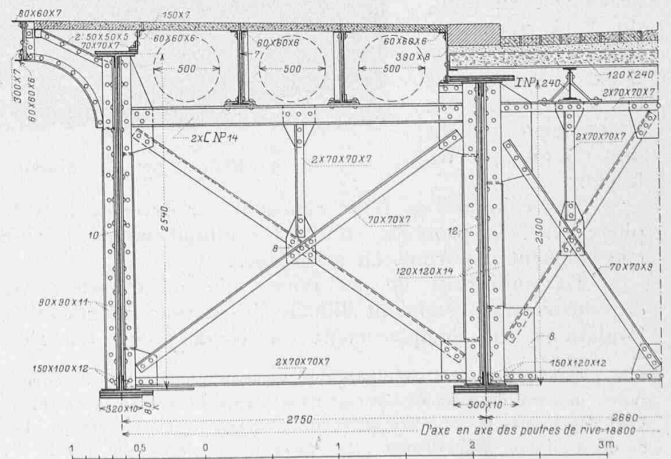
Coupe transversale sur piles. — Echelle 1 : 50.
